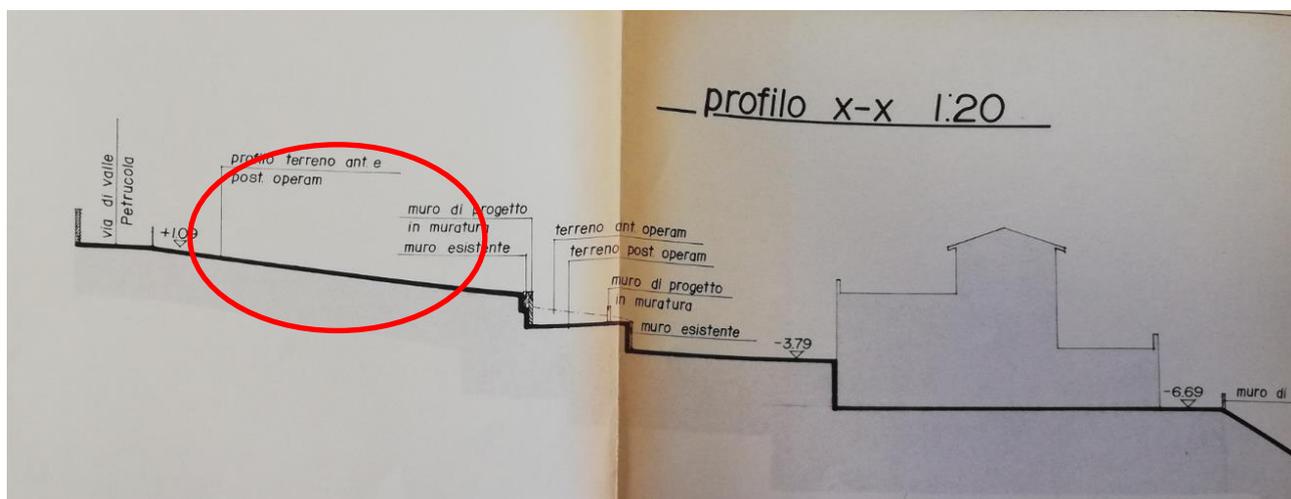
Stralci del progetto di realizzazione di muretti di contenimento (in rosso la posizione dei posti auto rilevati in situ)
